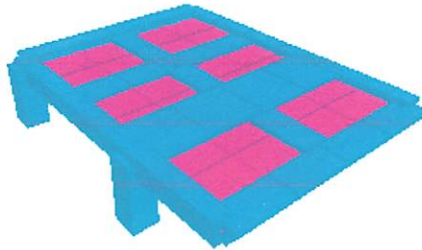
Pemodelan struktur lantai atap pada STAAD Pro
